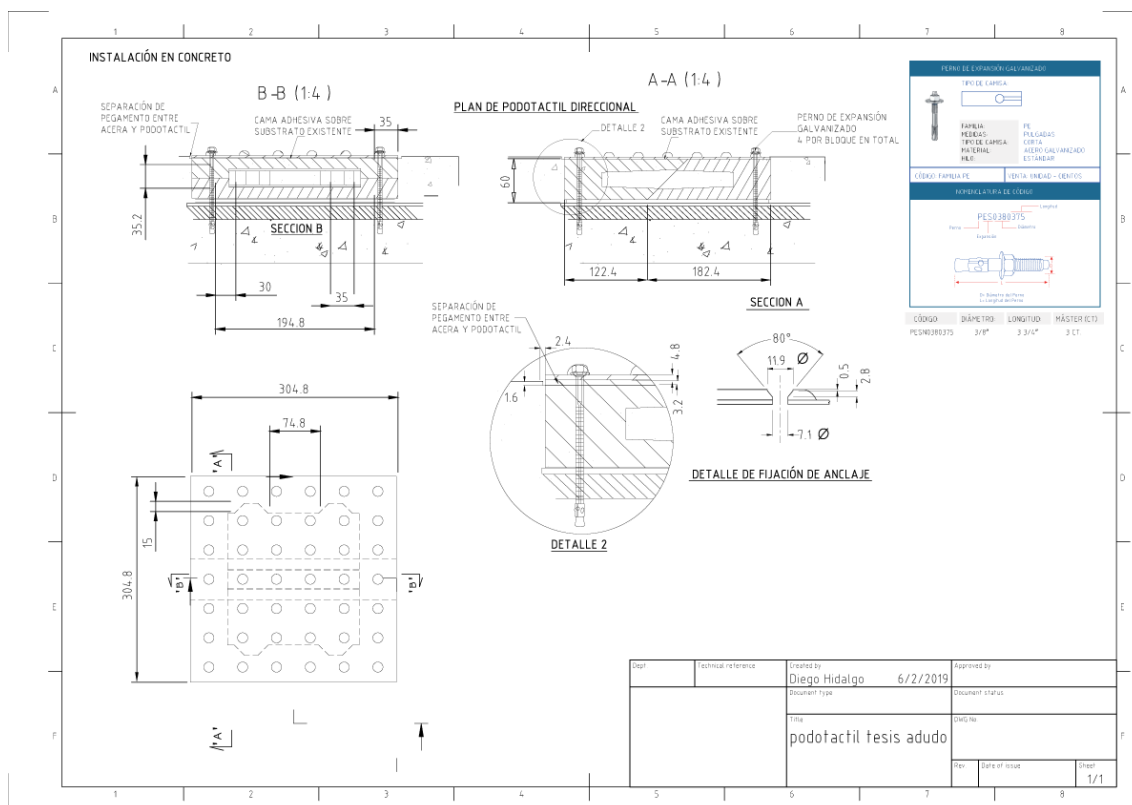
Plano de detalle de instalación de fonotáctiles para concreto.
